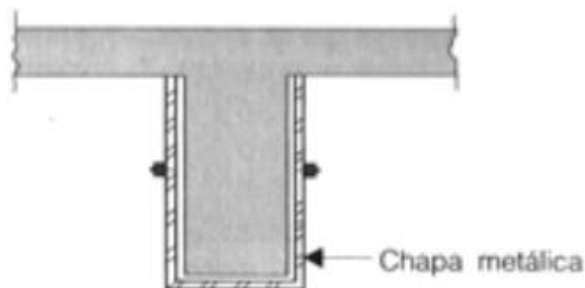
Corte da viga, estribo envolvendo viga. (Fernando G., et al 2002)
